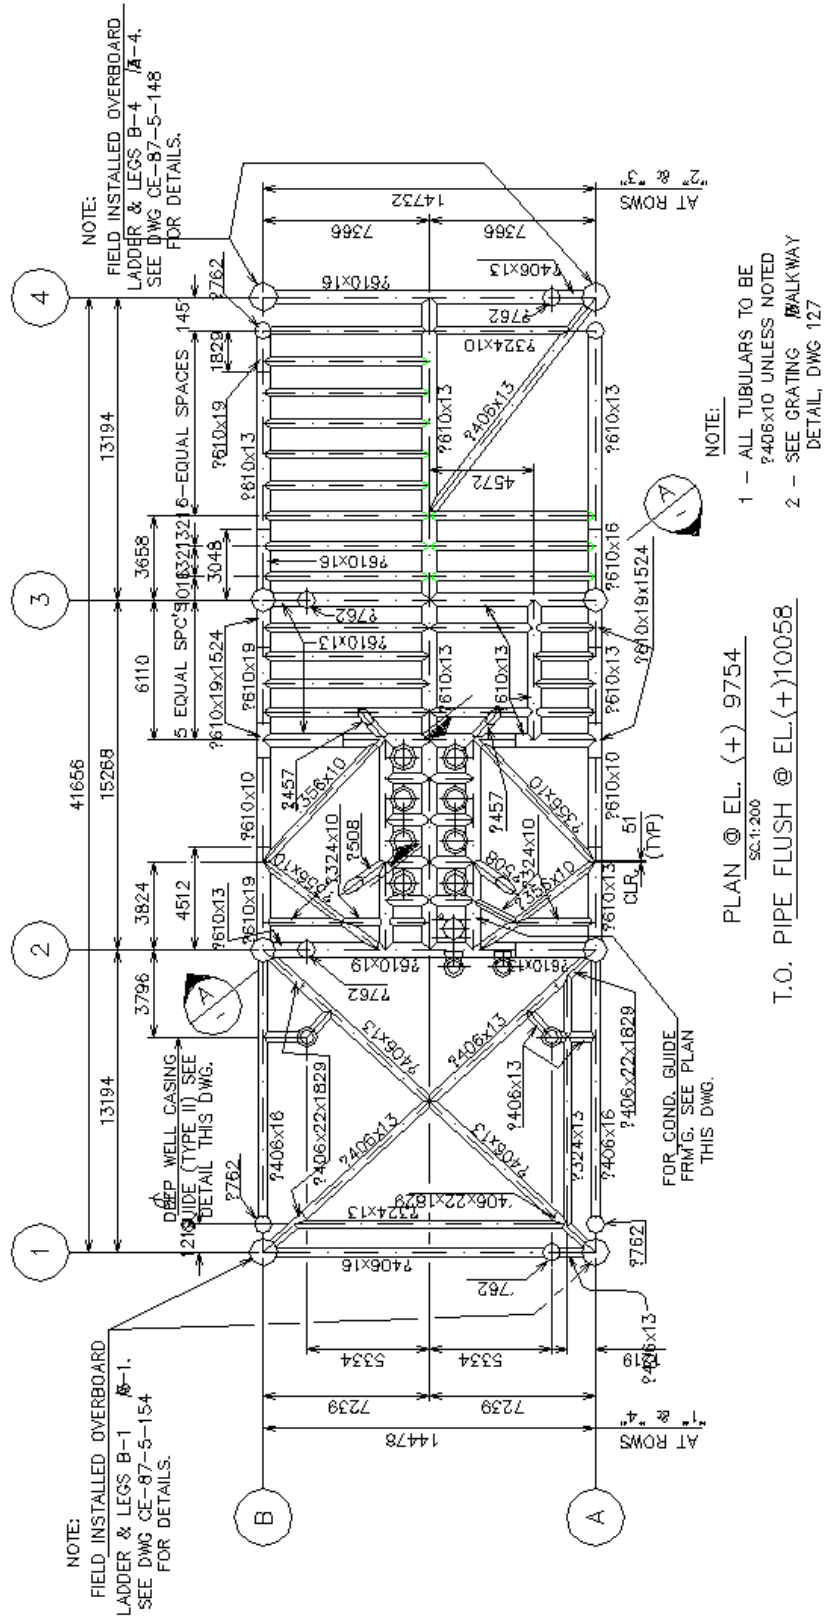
Planta baixa da elevação (+) 9754 mm (cotas em mm)
